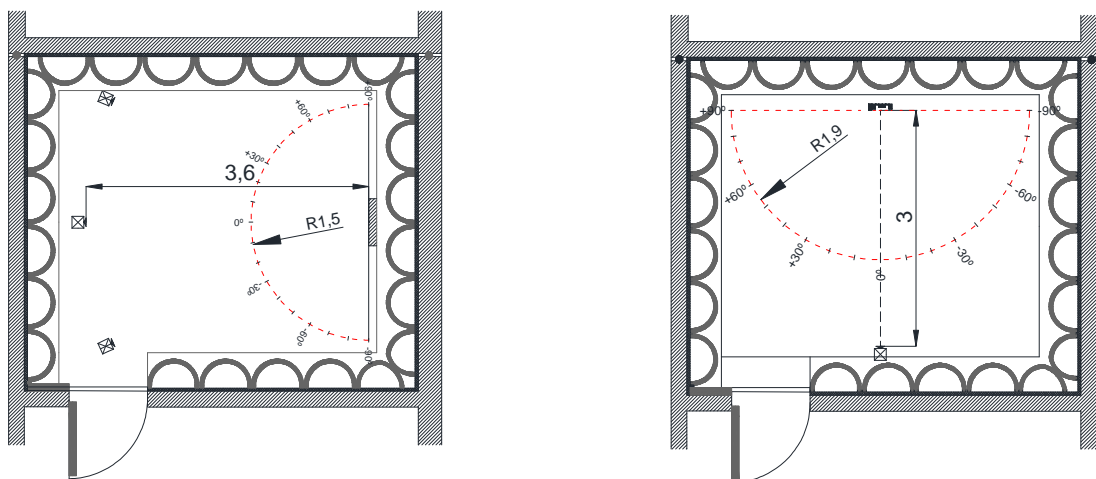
Dois layouts de teste possíveis (em planta).
